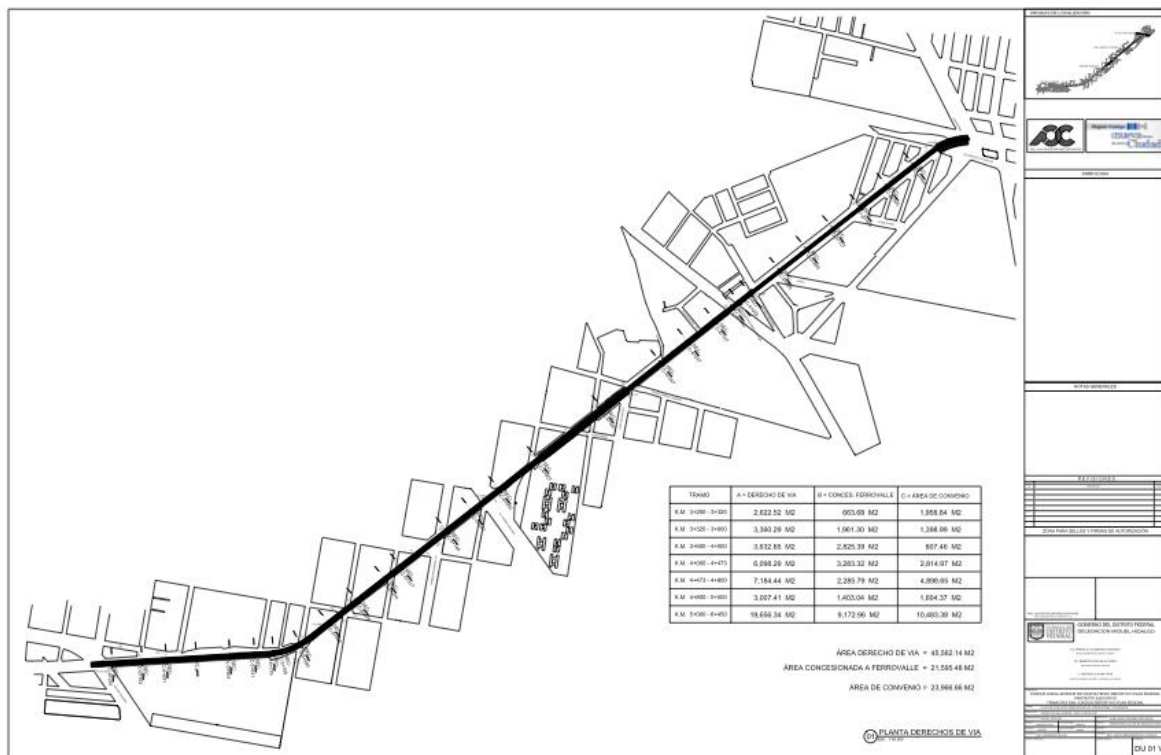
Plano del Derecho de Vía del FFCC de Cuernavaca
